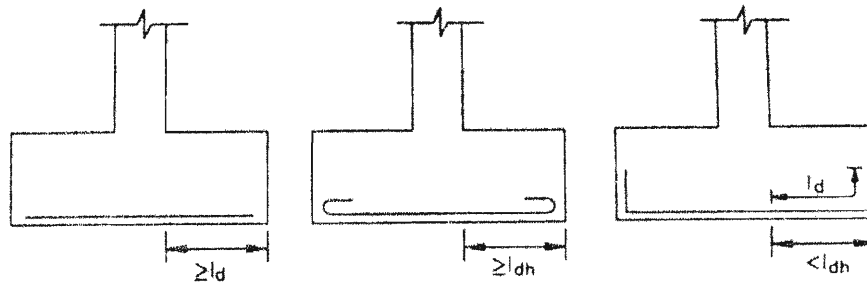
Tipos de anclaje del refuerzo longitudinal en cimientos
